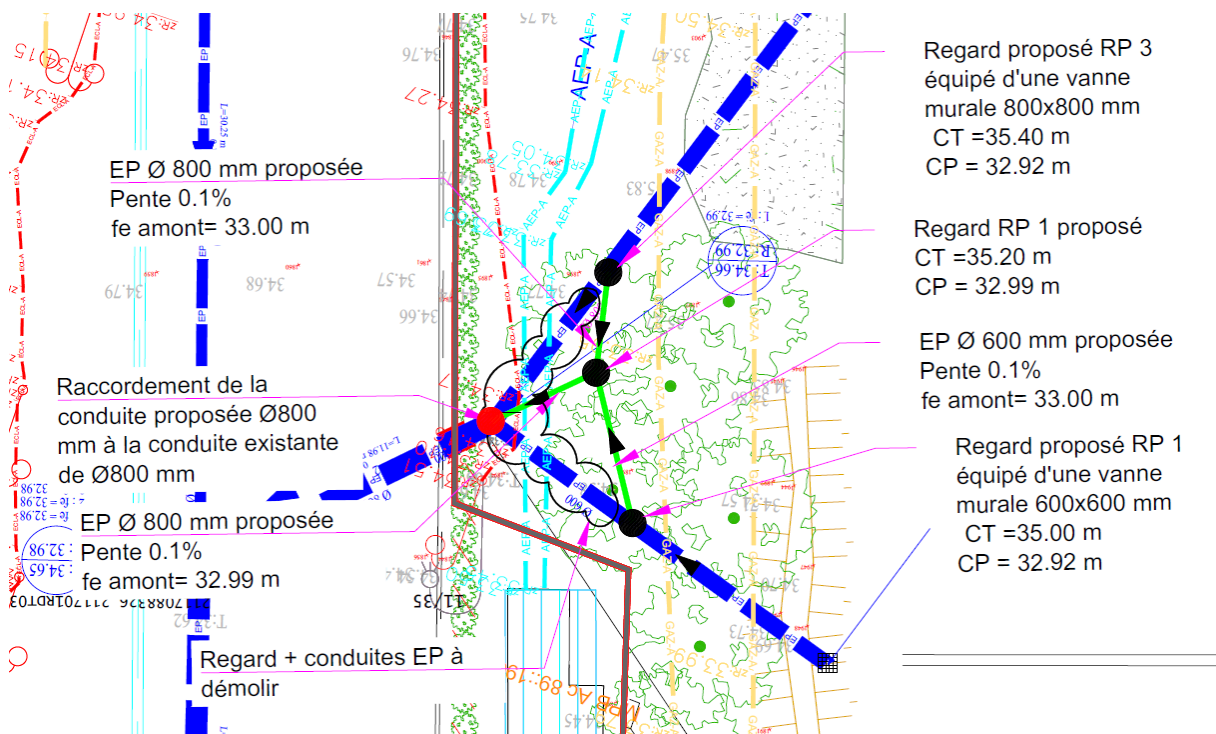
Décalage du regard existant d'une conduite de 800 mm
